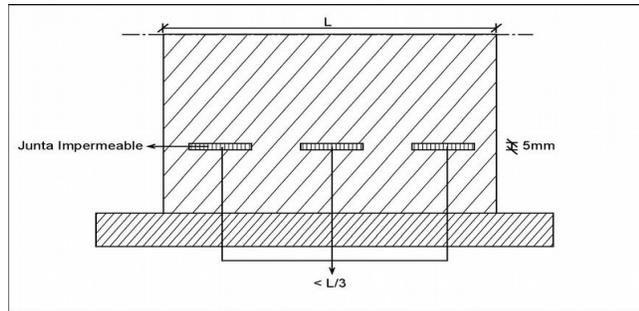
Corte transversal en un muro tratado en juntas impermeables
